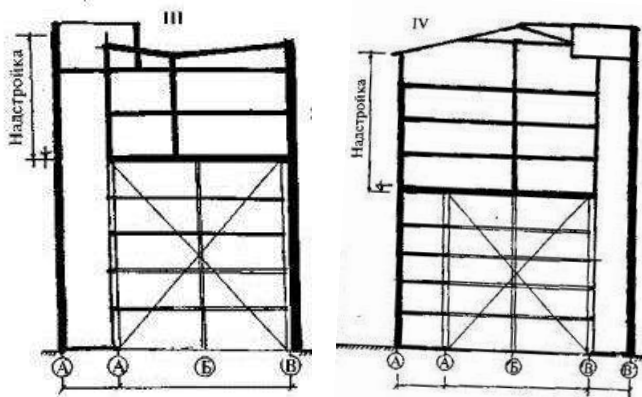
Конструктивно-технологические схемы реконструкции малоэтажных жилых зданий: III – одностороннего уширения корпуса зданий с надстройкой этажей; IV – двустороннего уширения корпусов зданий с надстройкой этажей.
